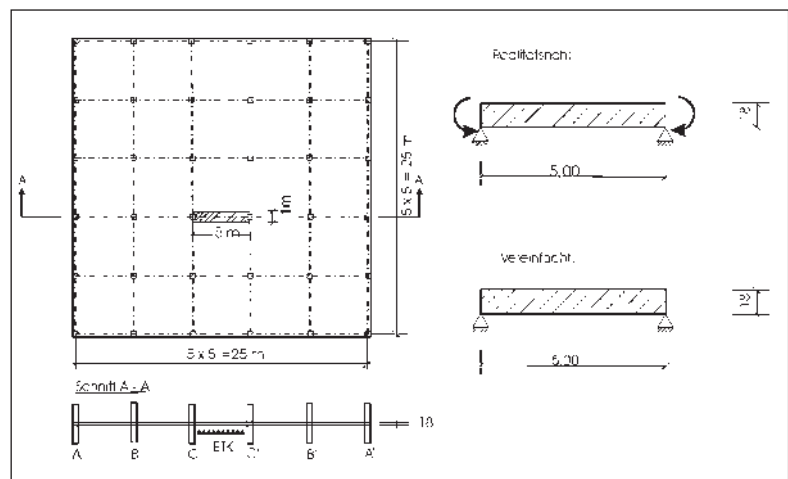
Bezug Versuchskörper zur Flachdecke mit Freier Spanngliedlage
